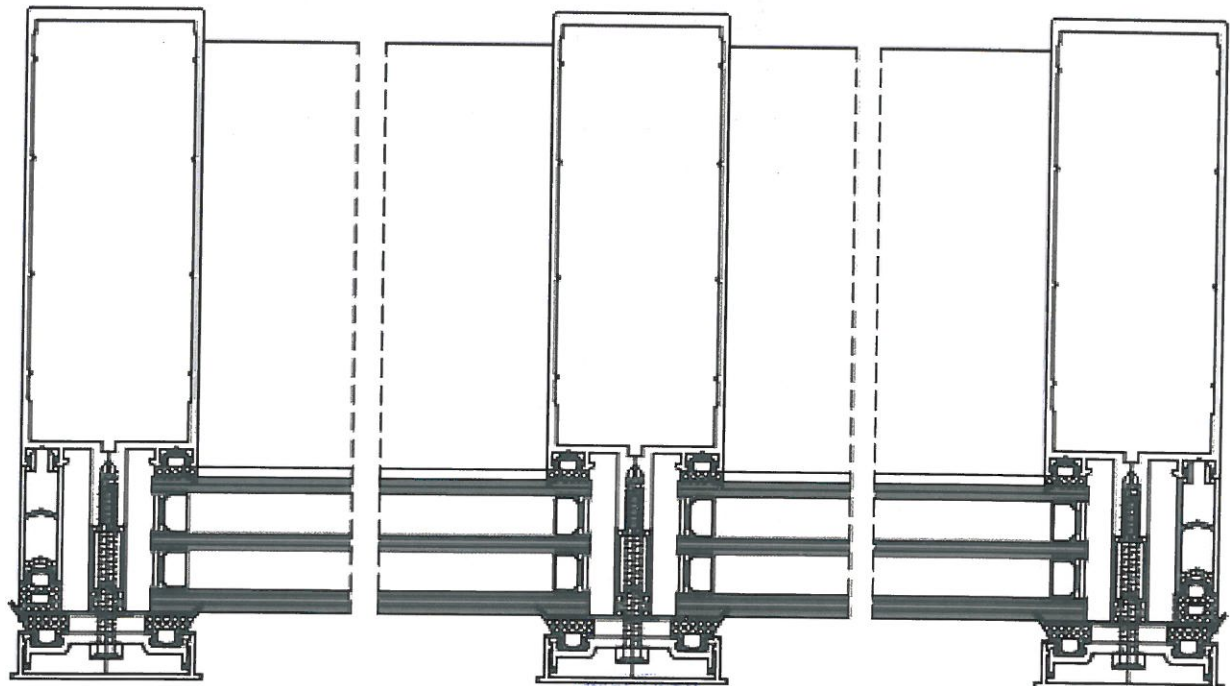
Горизонтальный разрез испытываемой конструкции.
